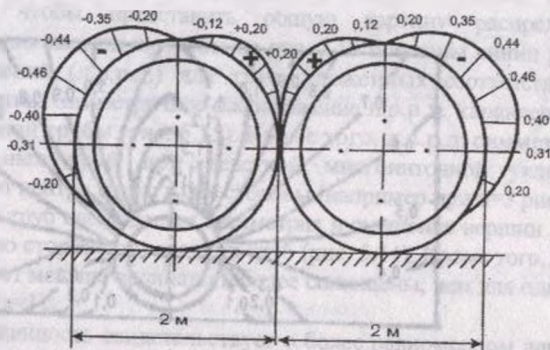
Эпюры радиального давления грунта на трубы двухниточной укладки.
